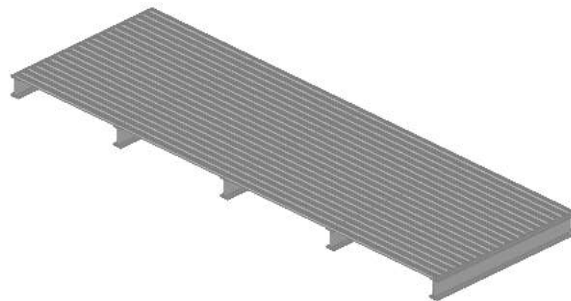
Sistema constructivo losacero. Elaboración: del autor. Año: 2017.
